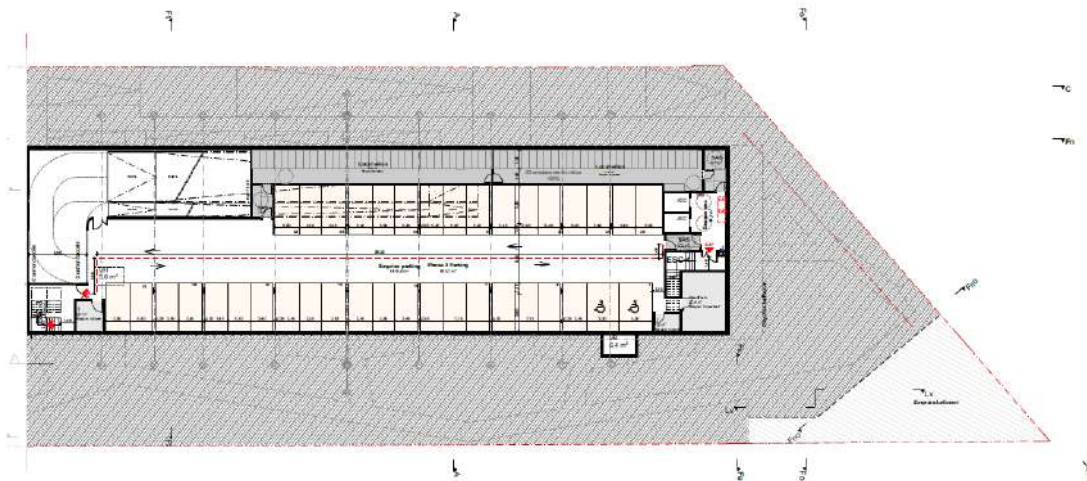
Plan du sous-sol du projet (janvier 2024)
